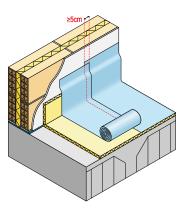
Colocación de la barrera impermeable sobre una capa anti-impacto de LM.
